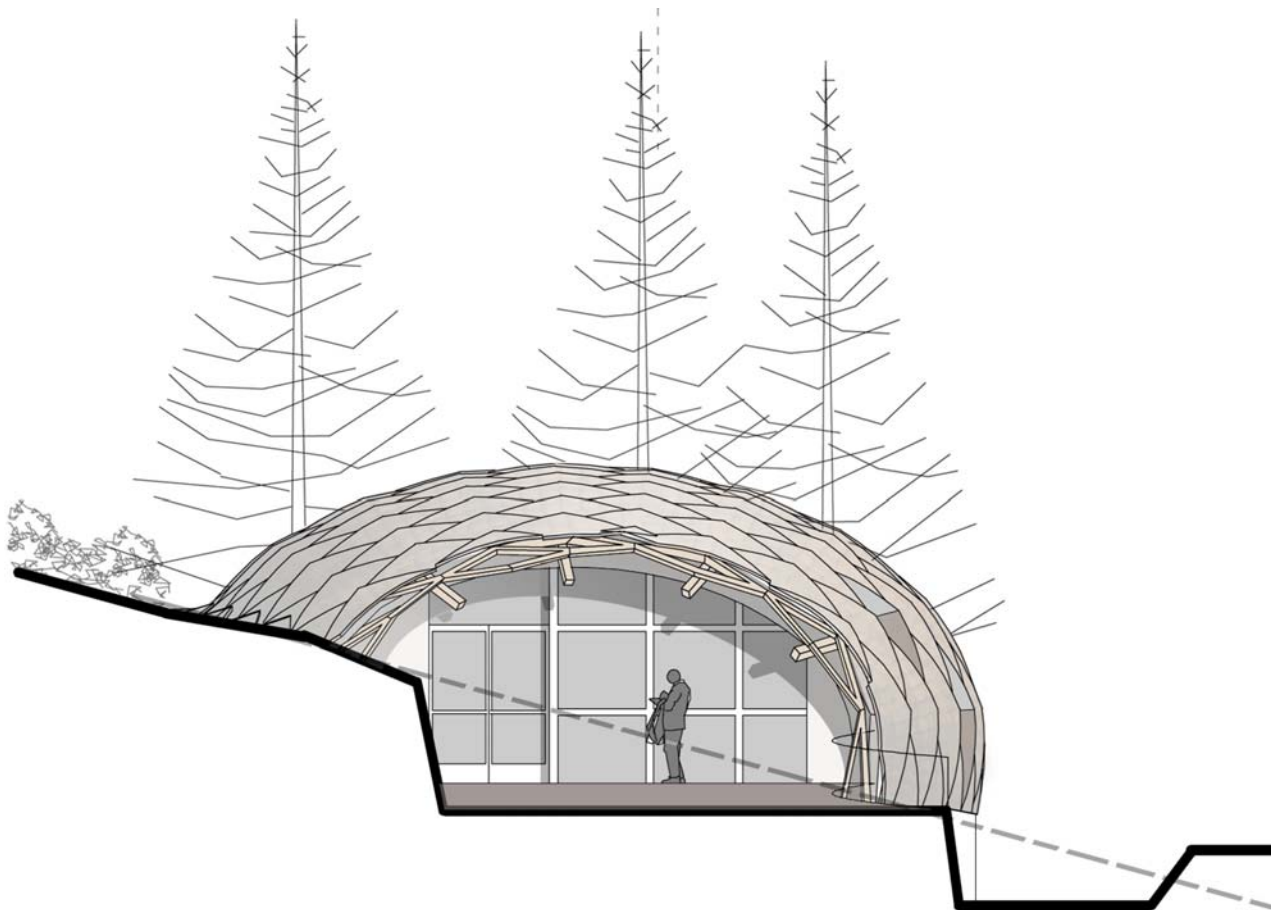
Foto da progetto – Prospetto frontale e sezione
